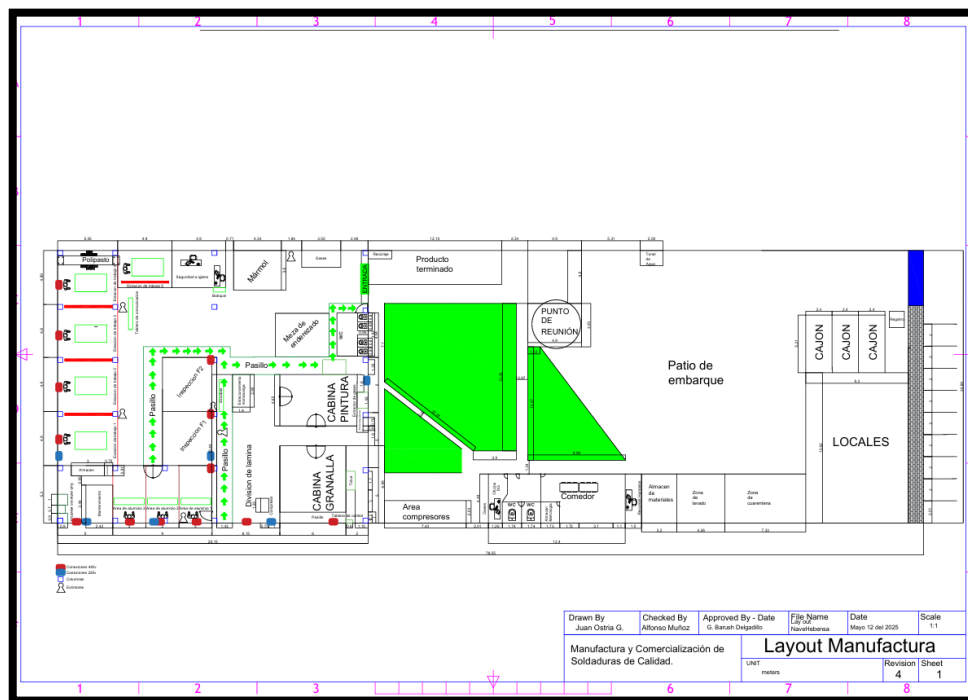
Layout Manufactura y comercialización de soldaduras de calidad.
